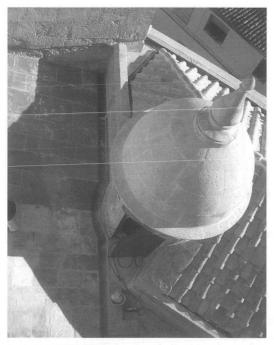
Trazado de la canal de la cubierta de cantería rodeando la garita de la escalera de acceso a las cubiertas (foto: Moliner 2007)
